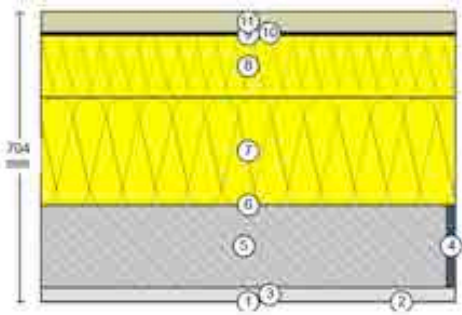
Bauteil, Dachbeläge, Decke Neu\_20cm
